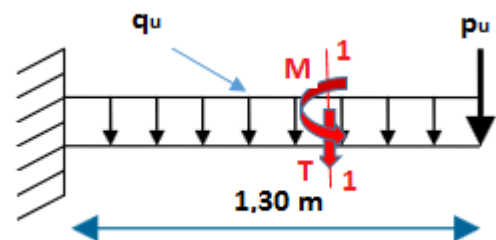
section 1-1 de la dalle a l'ELU
